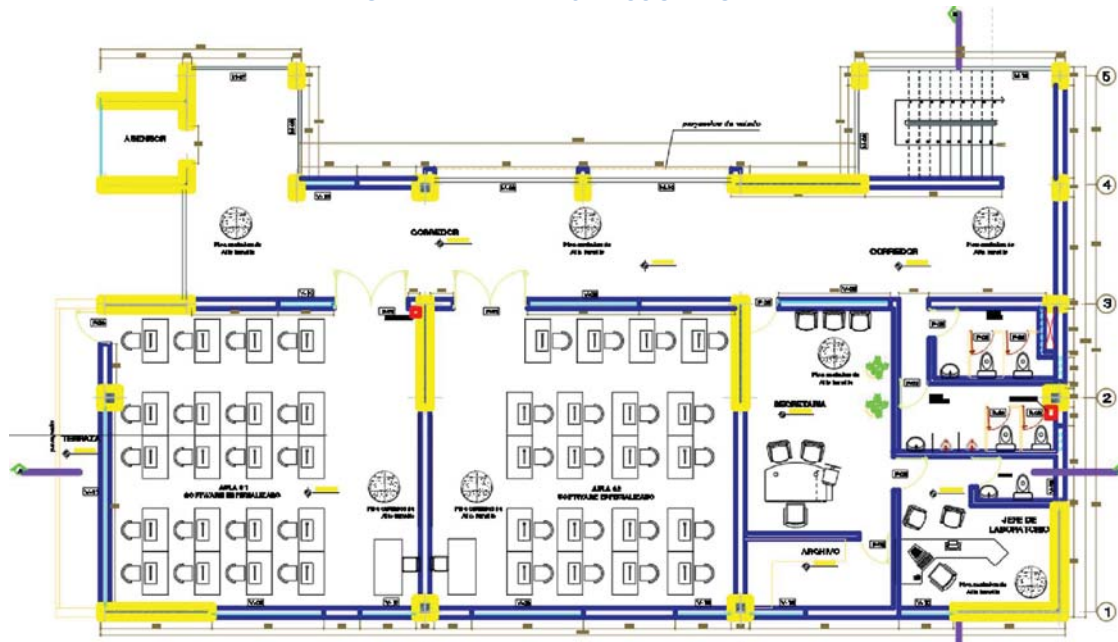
PLANTA DE DISTRIBUCION 3ER NIVEL
